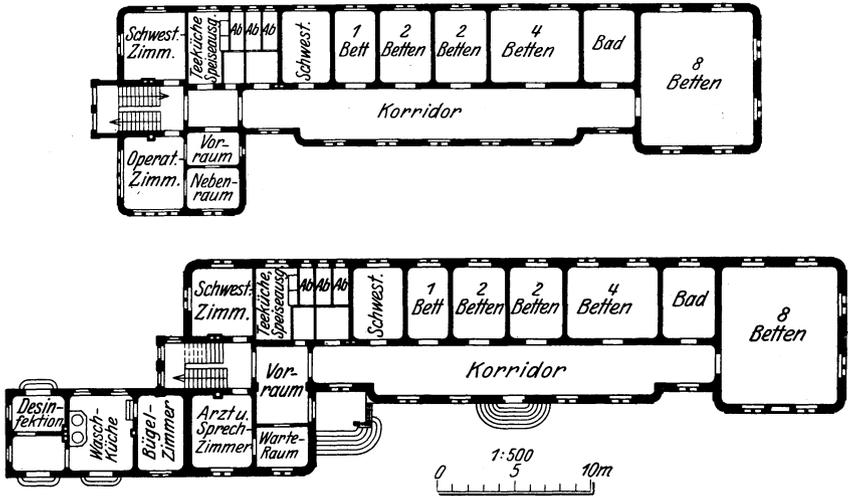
Alfeld i. H., Bezirkskrankenhaus, Hauptgebäude, 38 Betten, Ober- u. Erdgeschoß.
